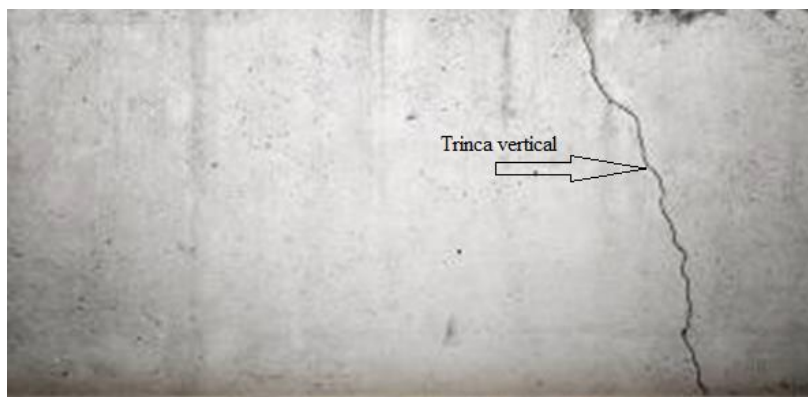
Fissura vertical alongada na parede de alvenaria
